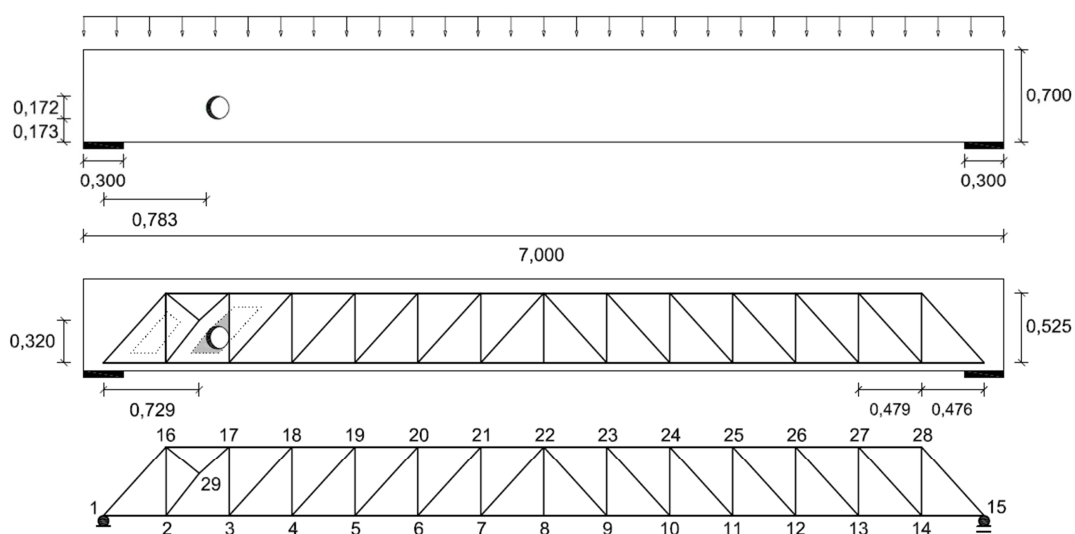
Elemento estrutural e treliça representativa (Viga 8) – Secção 0,70x0,30.
